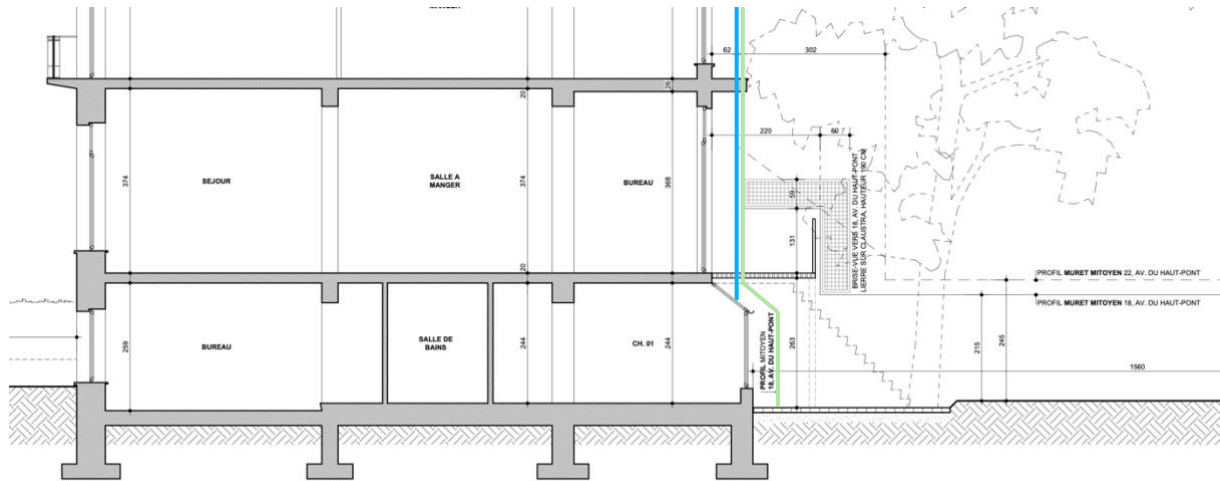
Mise en place d'un système de brise-vues vers le jardin voisin à l'aide d'un claustra sur lequel poussera des plantes grimpantes. Sur cette coupe sont également mis en évidence les profils des gabarits voisins de gauche (en vert) et de droite (en bleu).
